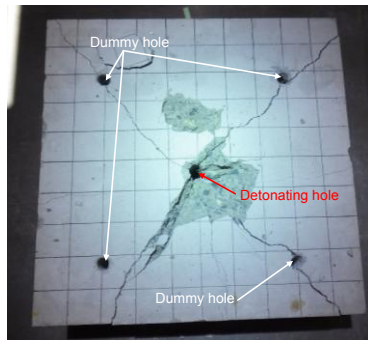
空孔を利用したひび割れ方向の制御例
